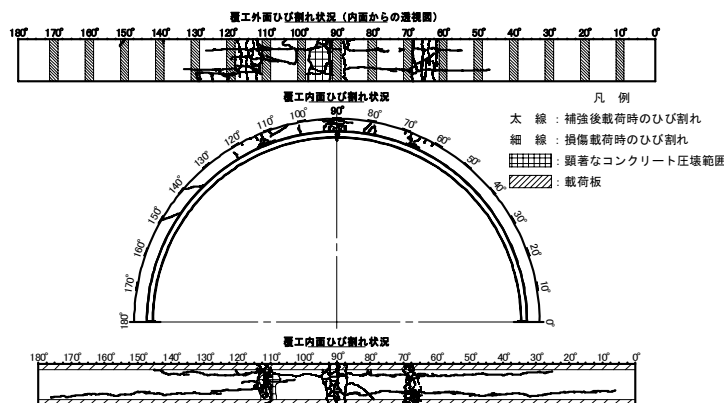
変状、ひび割れ状況図 (ケース 2)
